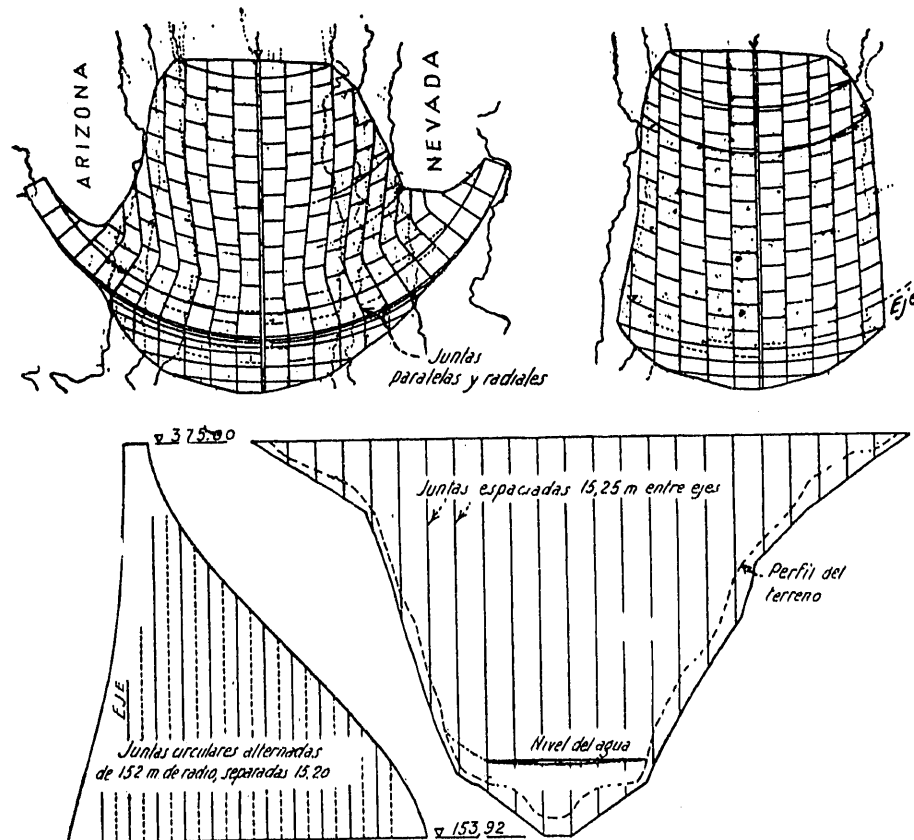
Plantas y secciones transversal y longitudinal indicando las juntas de contracción
